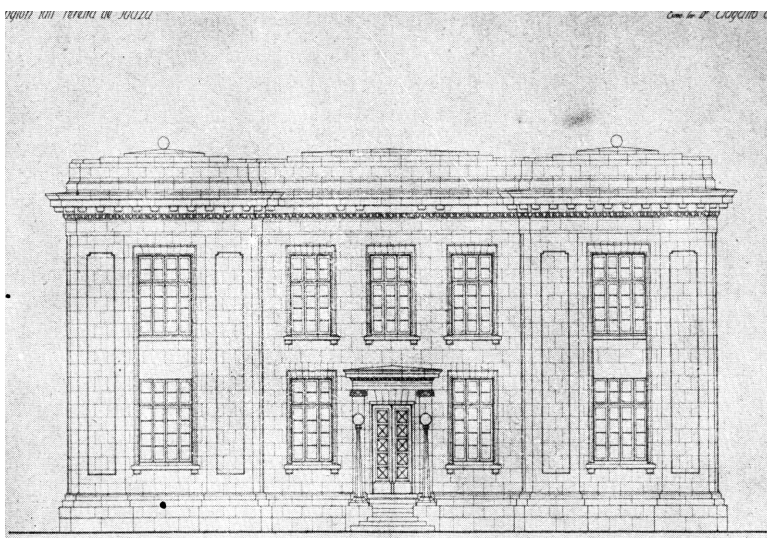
Planta da fachada lateral do Palácio Rio Branco.
